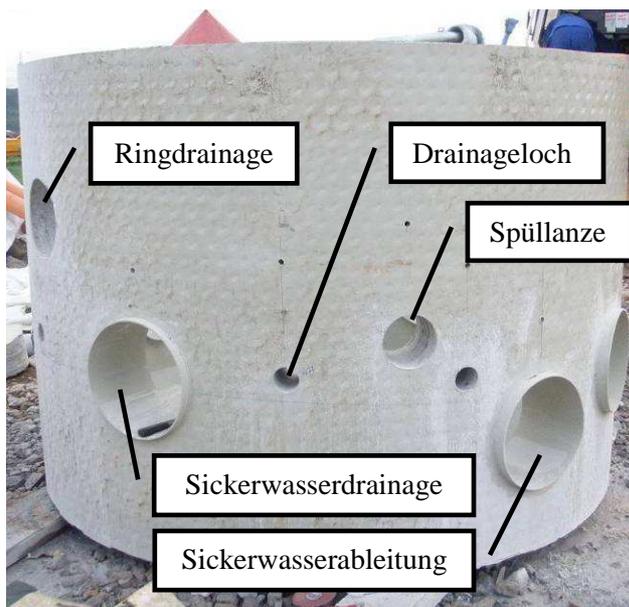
Schachtunterteil (Drainageschacht) mit ausgekleideten Anschluss- und Drainageöffnungen
